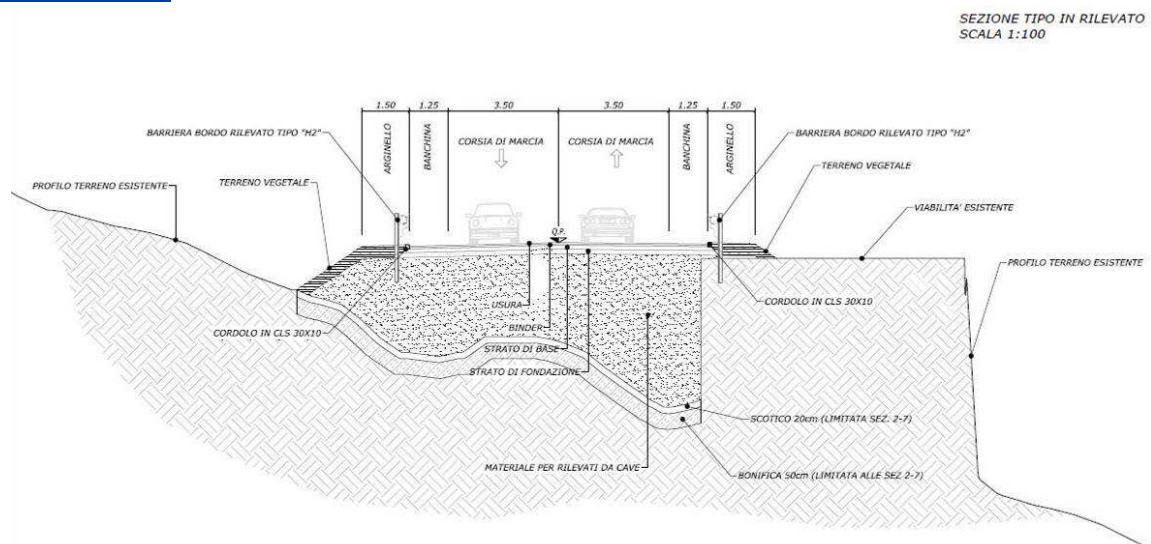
Sezione stradale di tipo C2 prevista per l'intervento in oggetto
